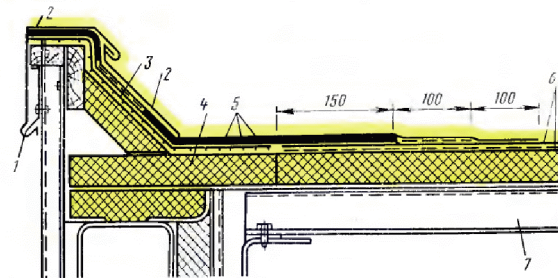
Устройство рулонной кровли на карнизе промышленного здания: 1 — климмера, 2 — фартуки из оцинкованной кровельной стали, 3 — слой рубероида (насухо), уложенный посыпкой втир, 4 — вкладыши, 5 — дополнительные слои кровельного ковра, 6 — основной кровельный ковер, 7 — панель покрытия
